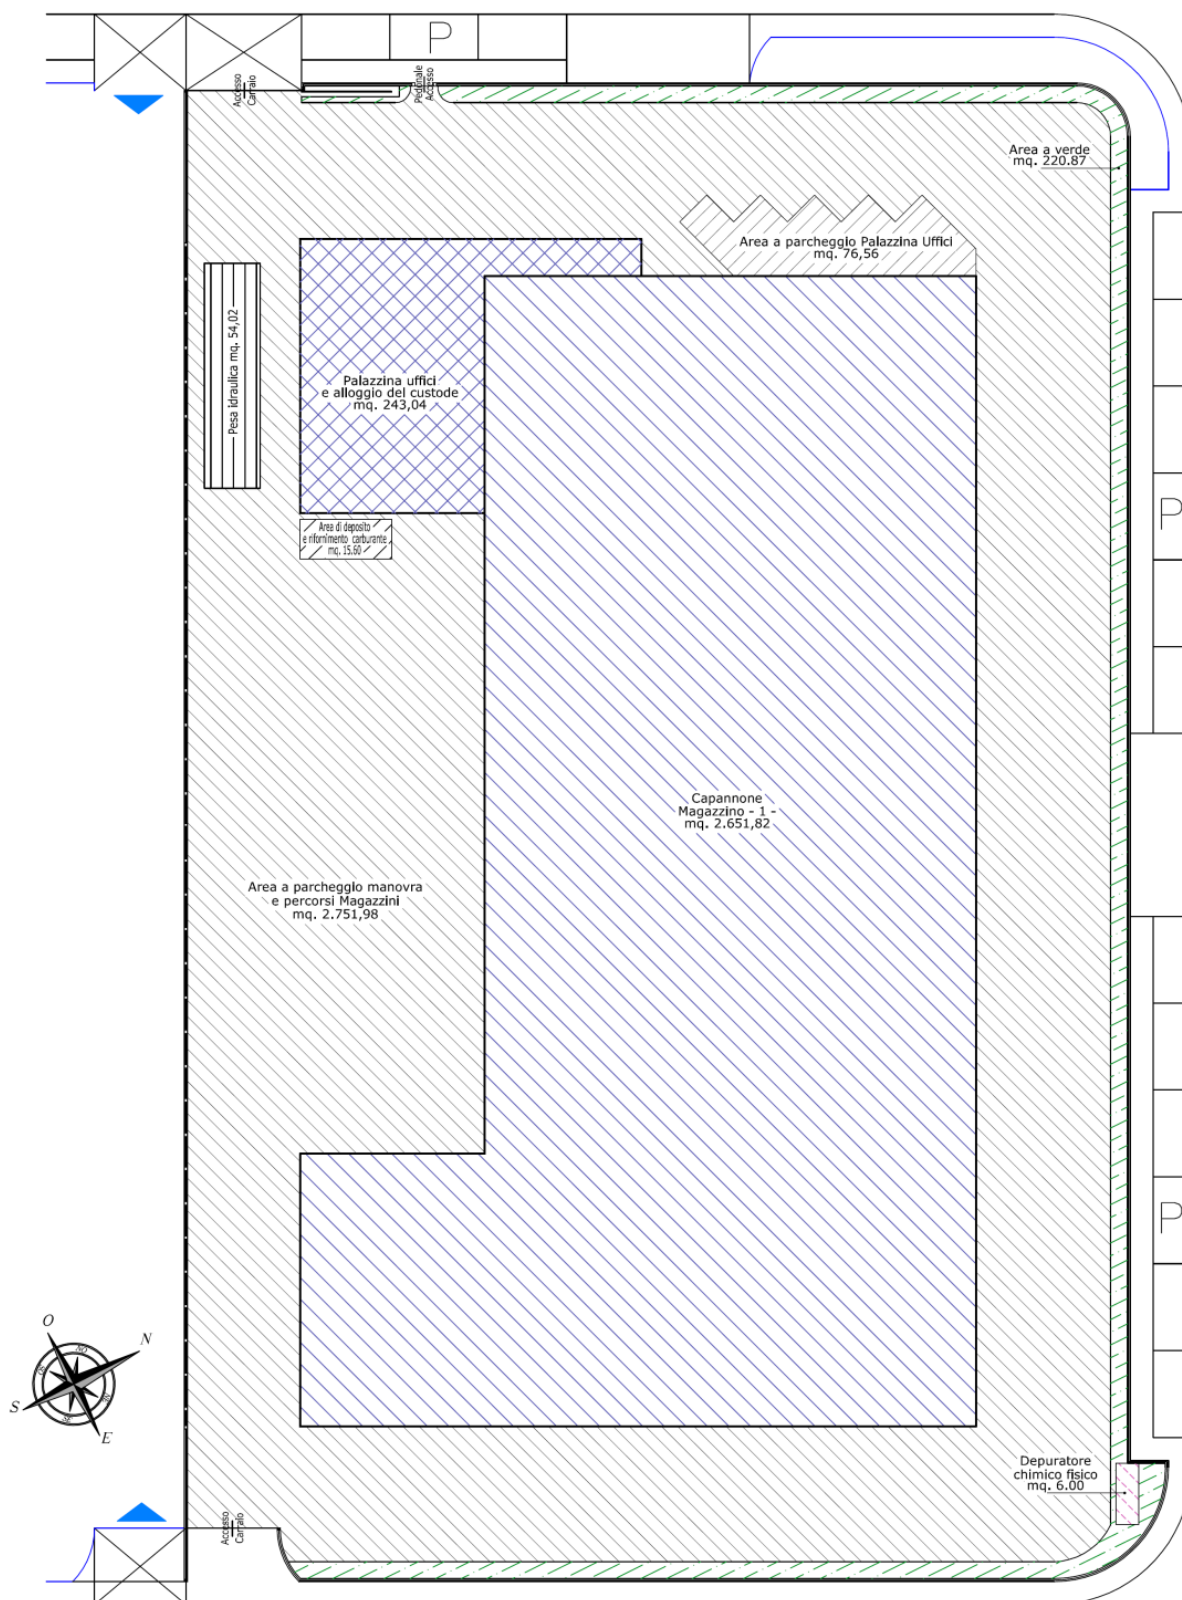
Estratto dall'Elaborato Grafico di Tavola n. A2.6 del Progetto Definitivo – Sviluppo piani volumetrico e individuazione destinazione delle superfici.
